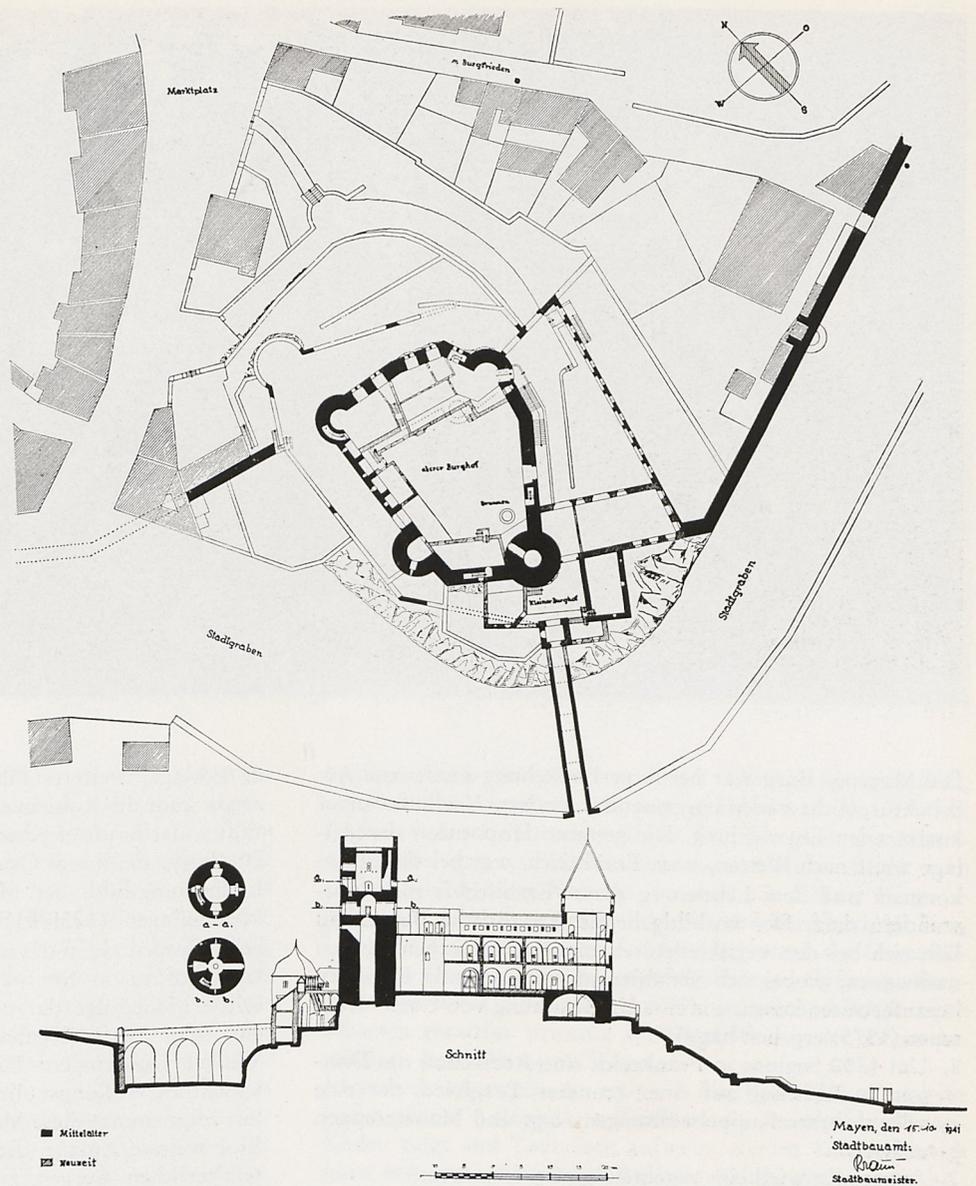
Lageplan und Grundriß der Burg Mayen. Aufgenommen vom Stadtbauamt Mayen 1941. (Abb. DBV-Archiv).
